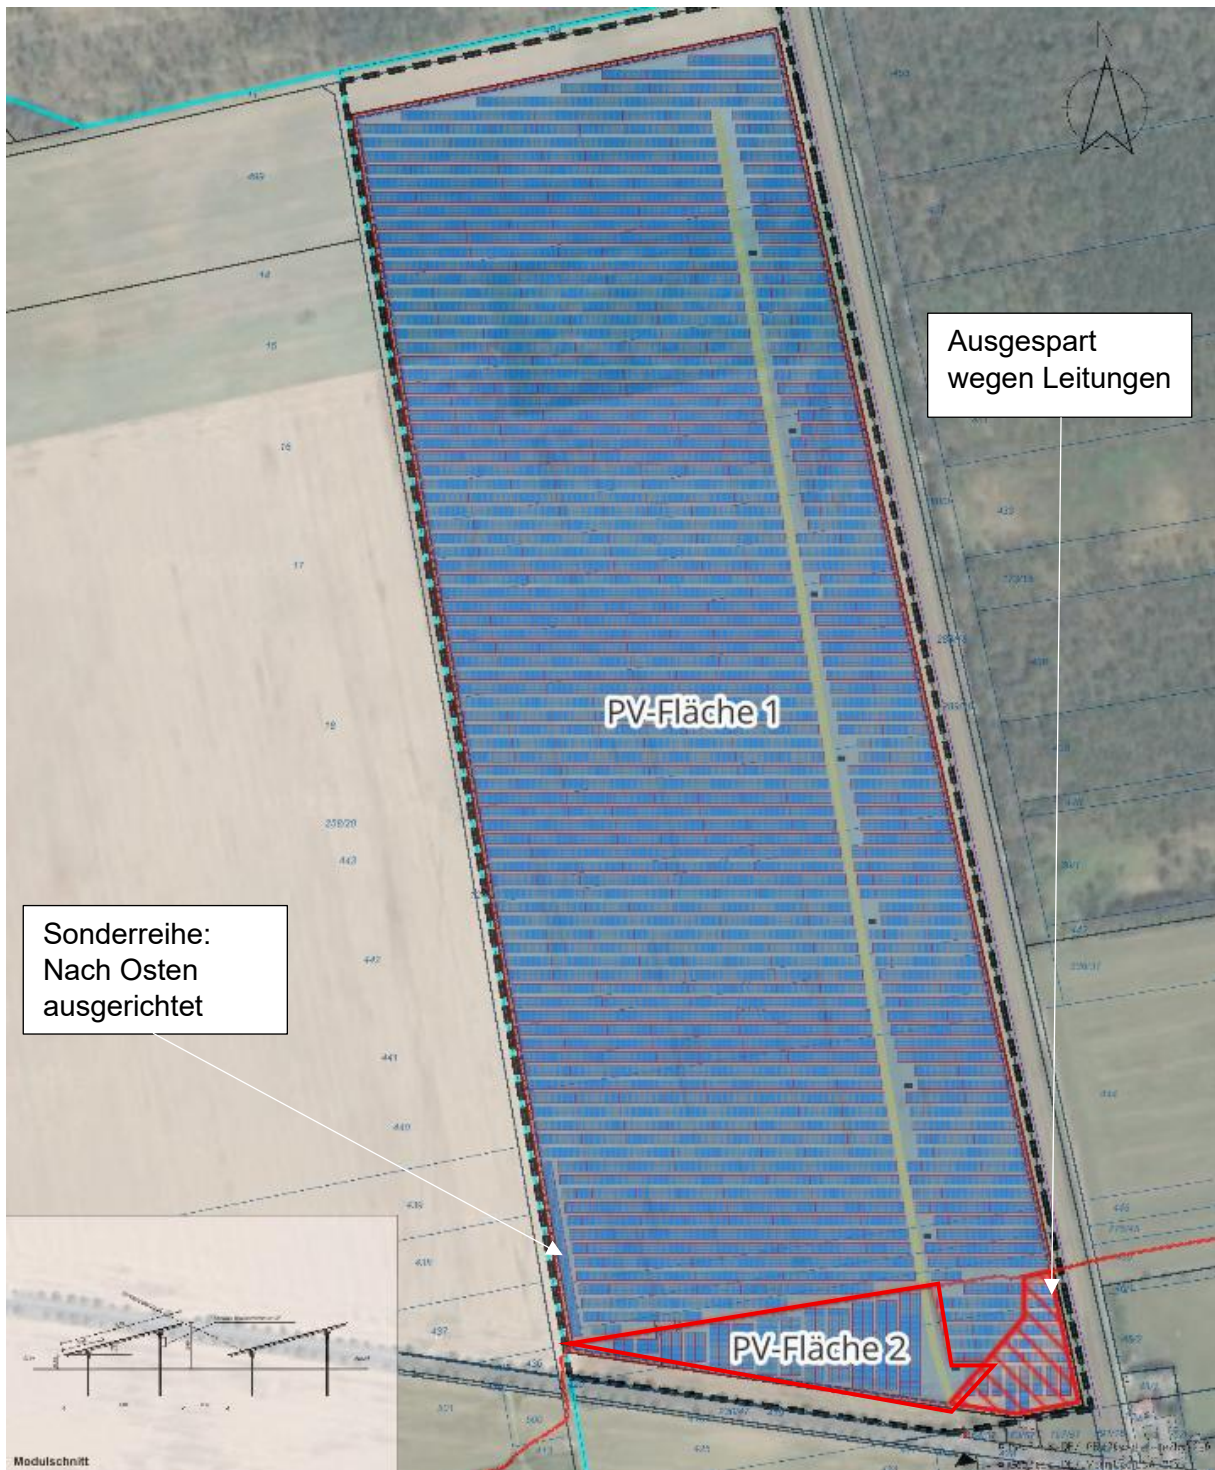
Grundriss der PV-Flächen - Quelle Satellitenbild: Google Earth Pro
